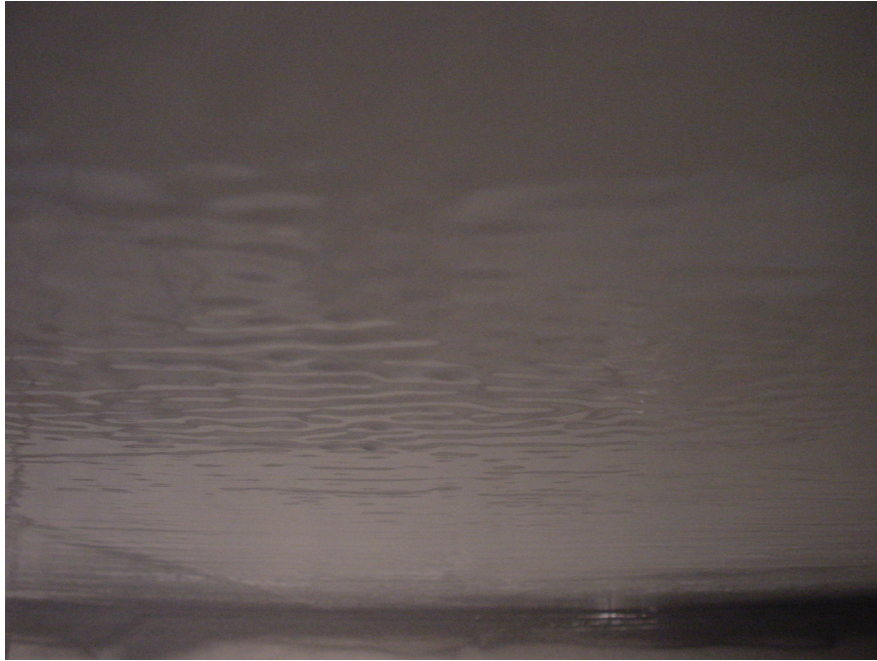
Ungenügender Verlauf einer Beschichtung auf einer Betondecke
